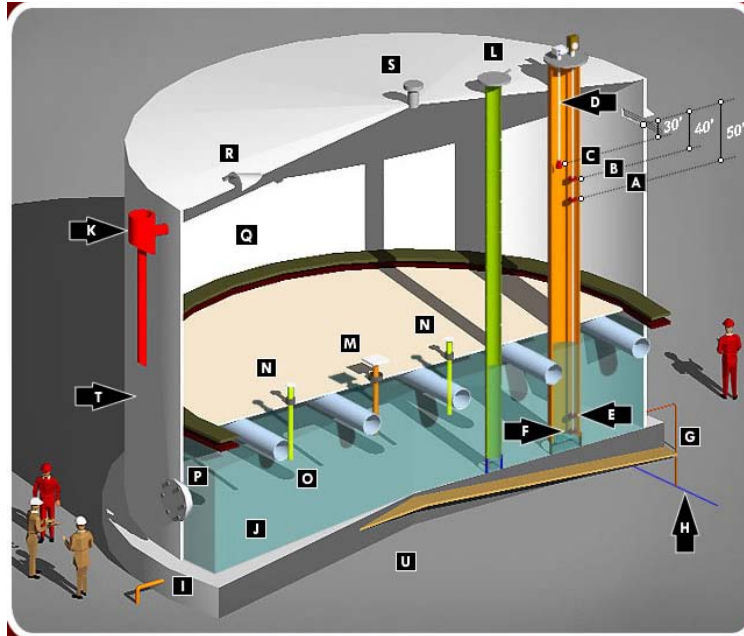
Tanque vertical con techo fijo y M.F.I. de aluminio.
